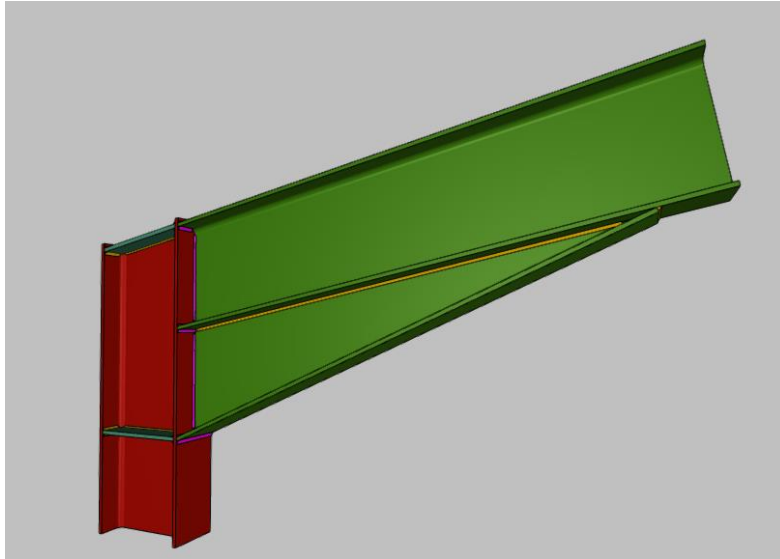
Detalle unión pilar - viga soldada [7].
